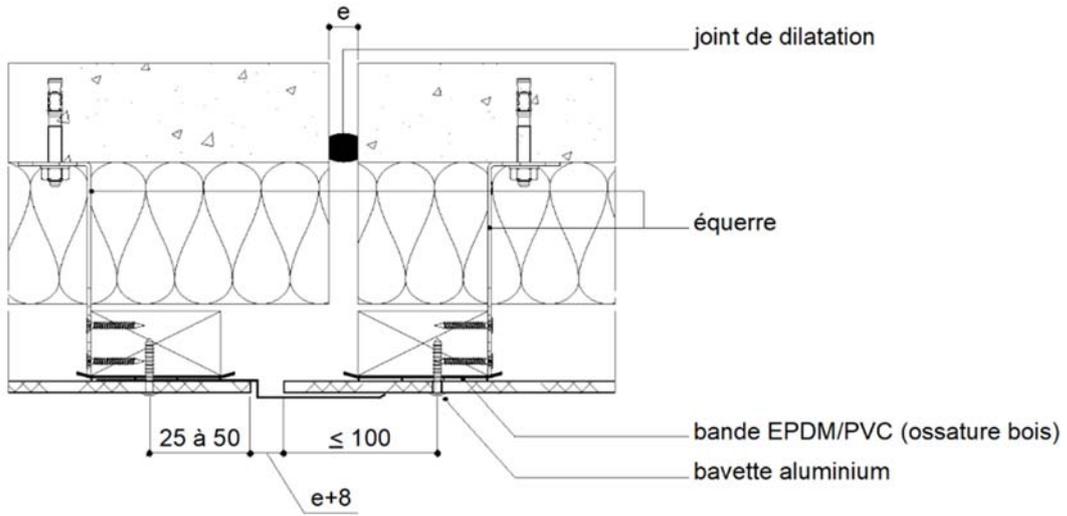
Détail joint de dilatation sur ossature bois ou métallique (cote en mm)
